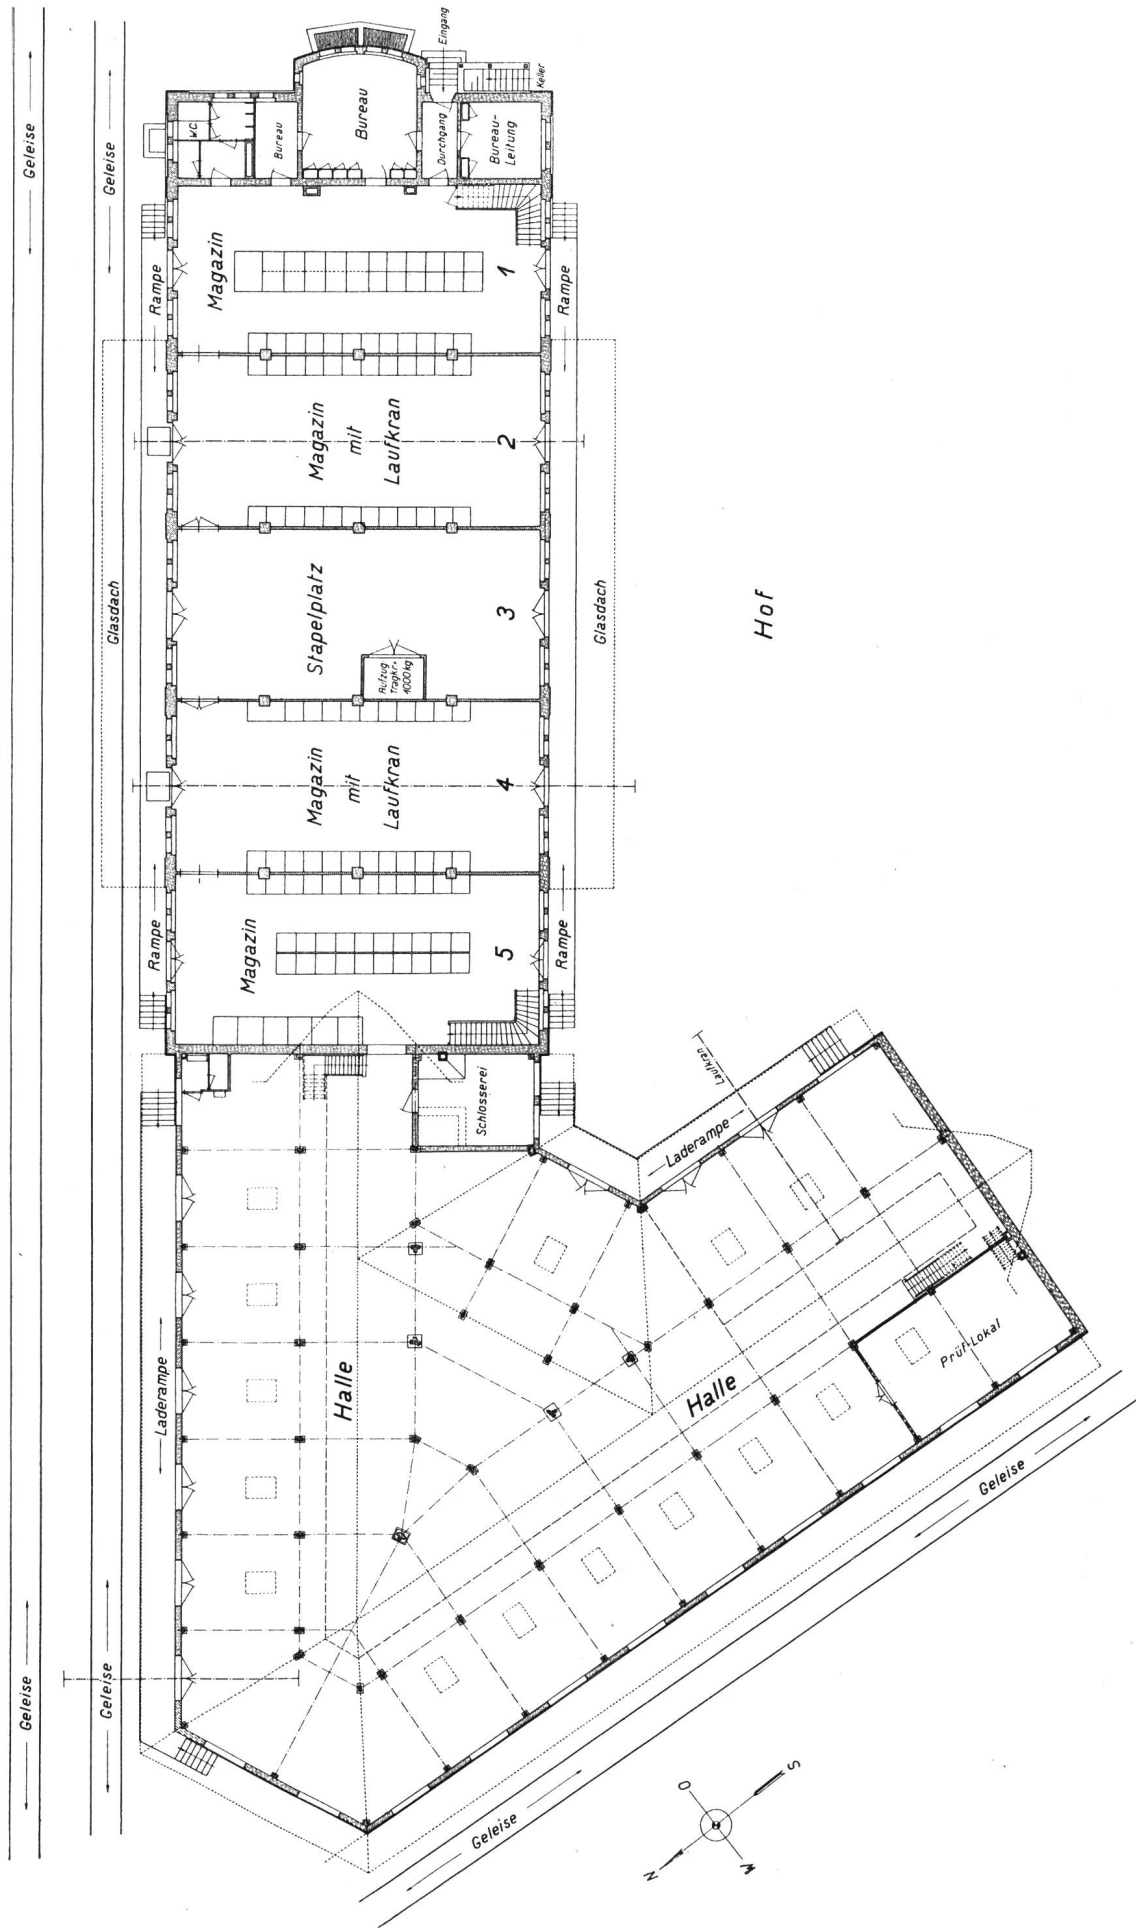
Grundriss des Hauptmagazins und der Kabel- und Eisenhalle.
